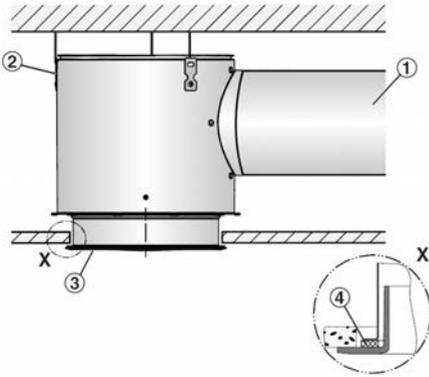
Montage à ras du plafond avec caisson de raccordement circulaire
